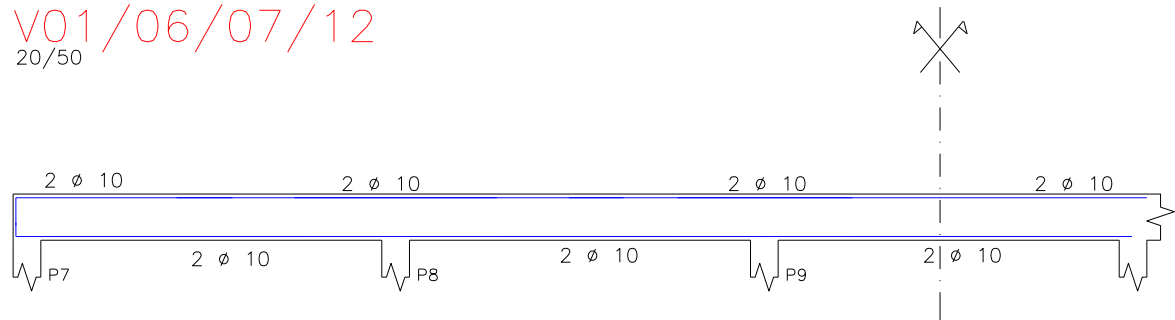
Esquema do dimensionamento à flexão das vigas dos pavimentos tipo
